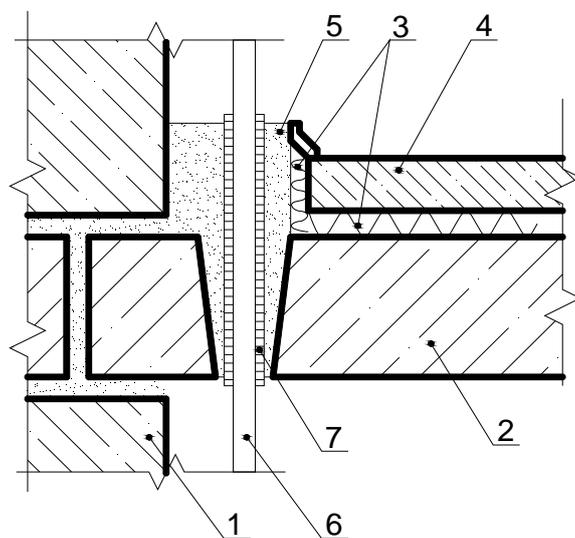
Схема конструктивного решения узла пропуска стояка отопления через междуэтажное перекрытие:
